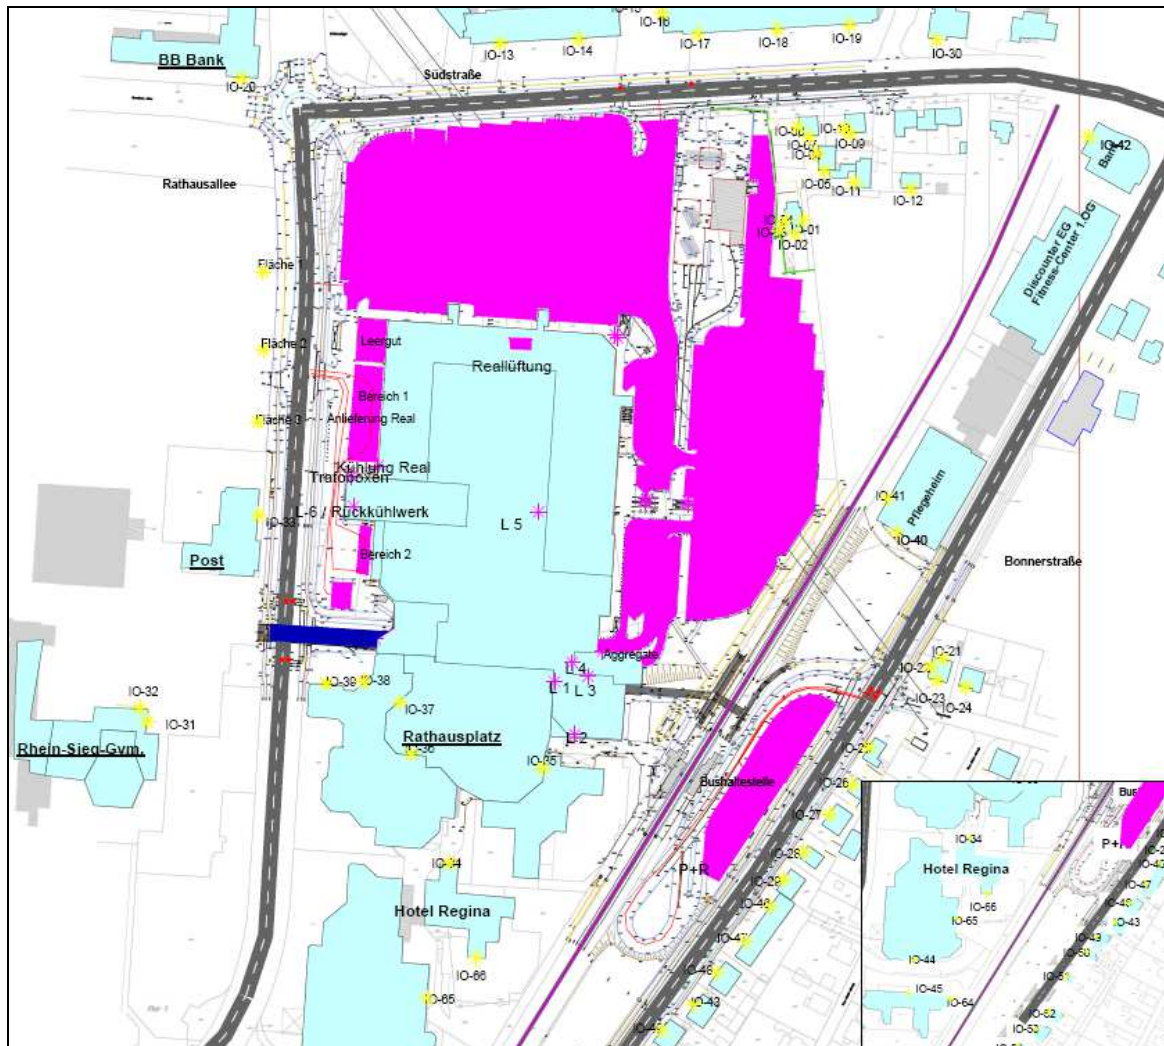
Lageplan Ist-Zustand (Anlage 1.1)
